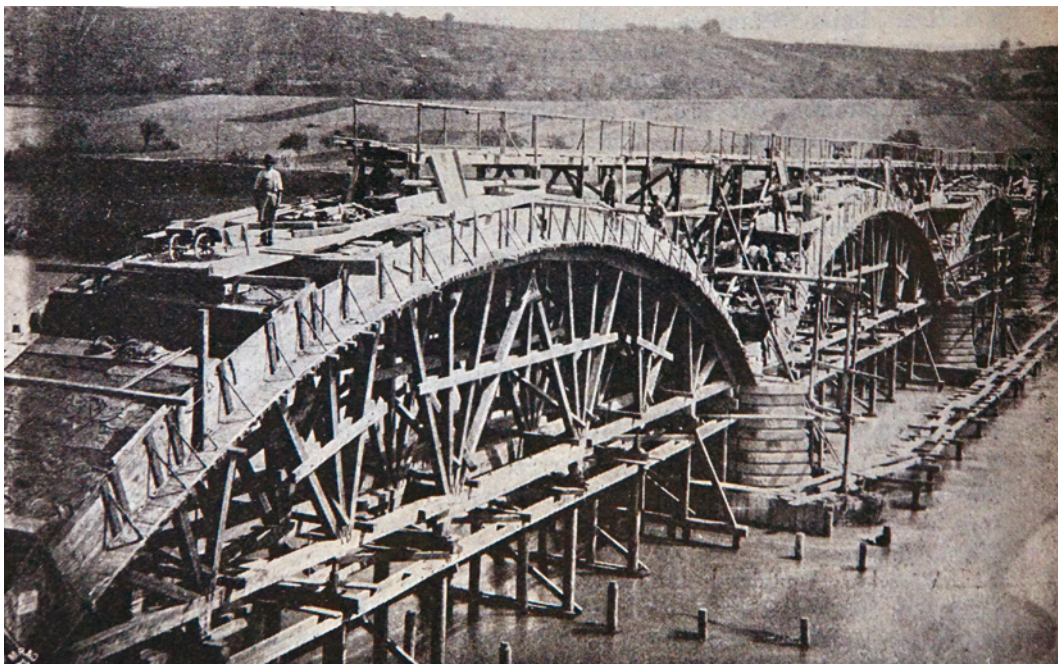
Übernahme des Bauverfahrens des Wölbens in Abschnitten in den reinen Betonbau (Neckarbrücke Kirchheim, 1895; Büsing 1905, S. 310)
